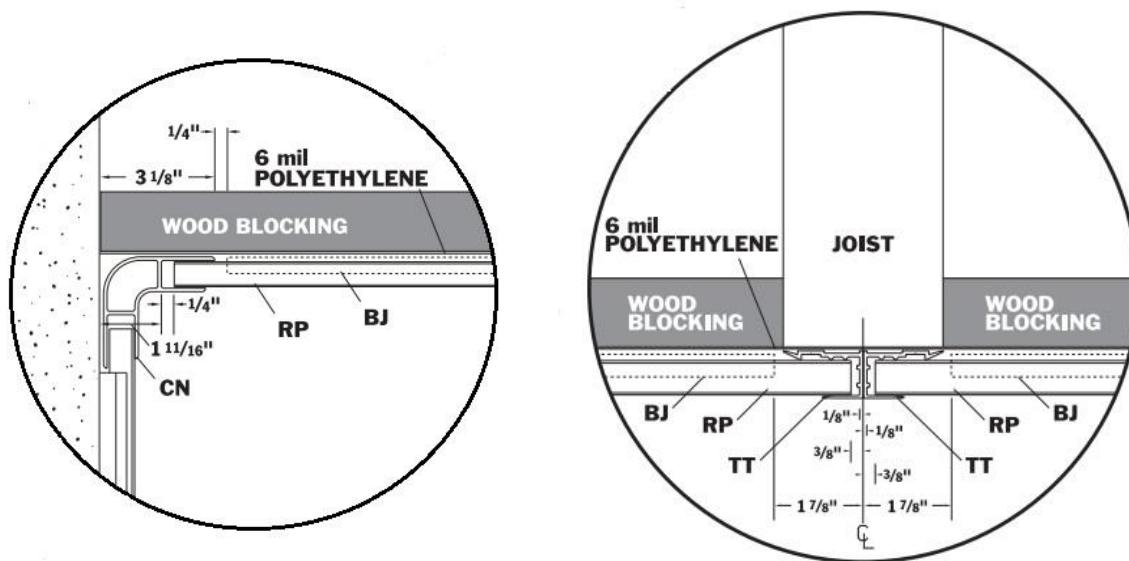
Pormenores de ligação painéis de teto: ligação a parede (esq.) e ligação a travessa de telhado (dir.)
